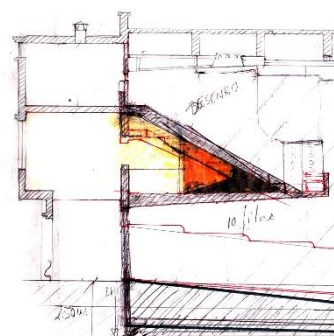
Corte da alteração de inclinação do balcão.
